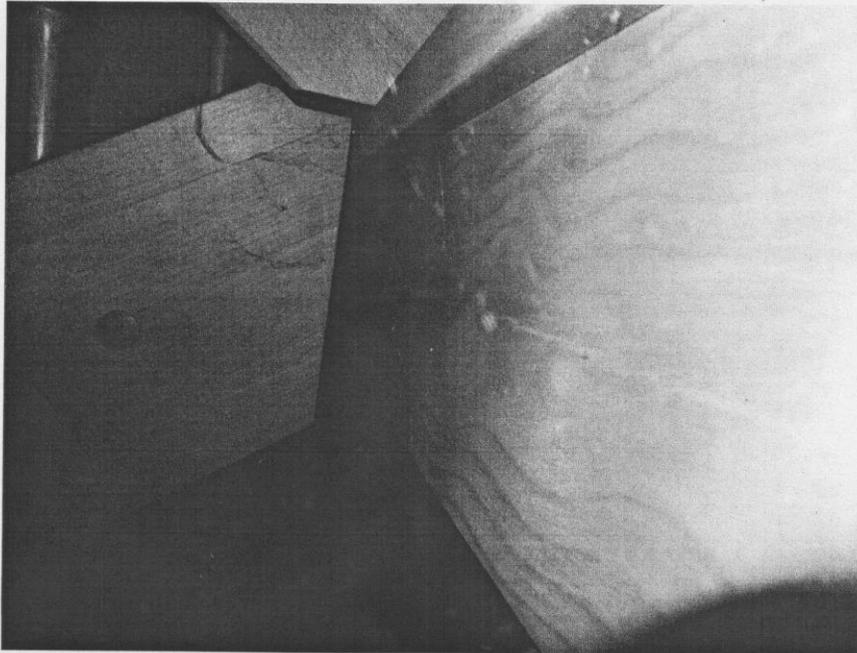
Anschluss Treppenwange an Kellertreppenpodest
